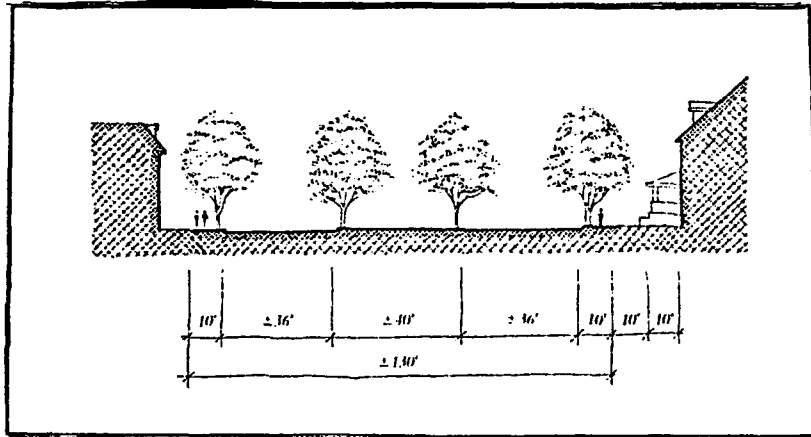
Cours Mirabeau Caddesi Planı (Ölçek: 1/600)
